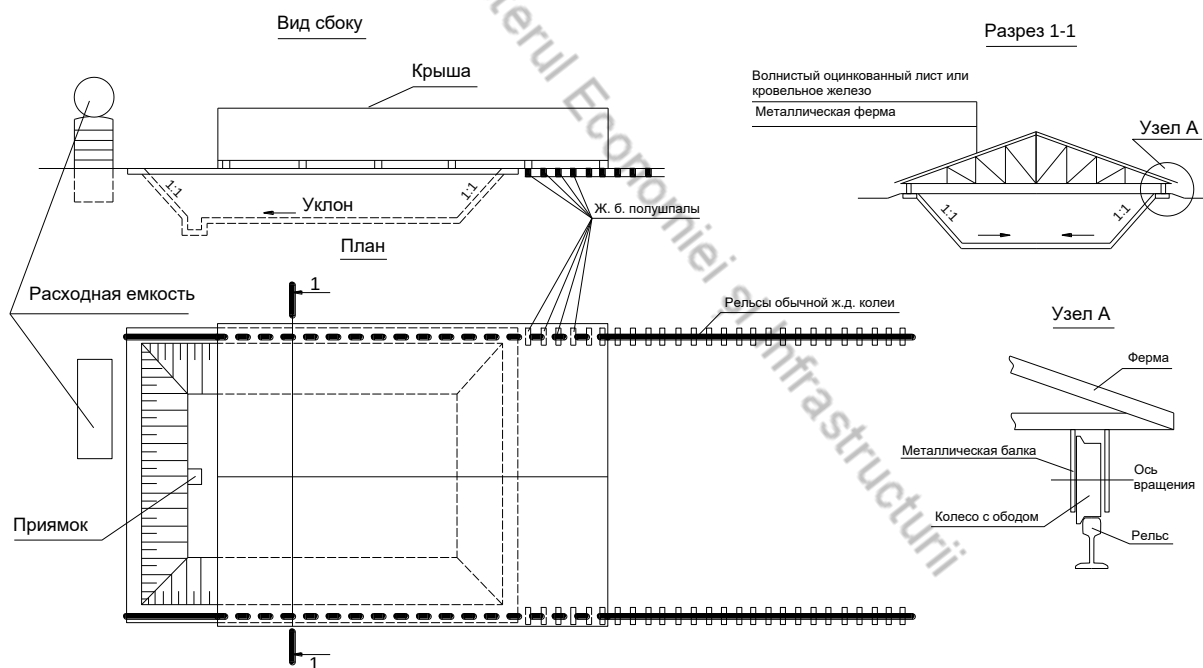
Схема хранилища для жидких ПГМ со сдвигаемой крышей
